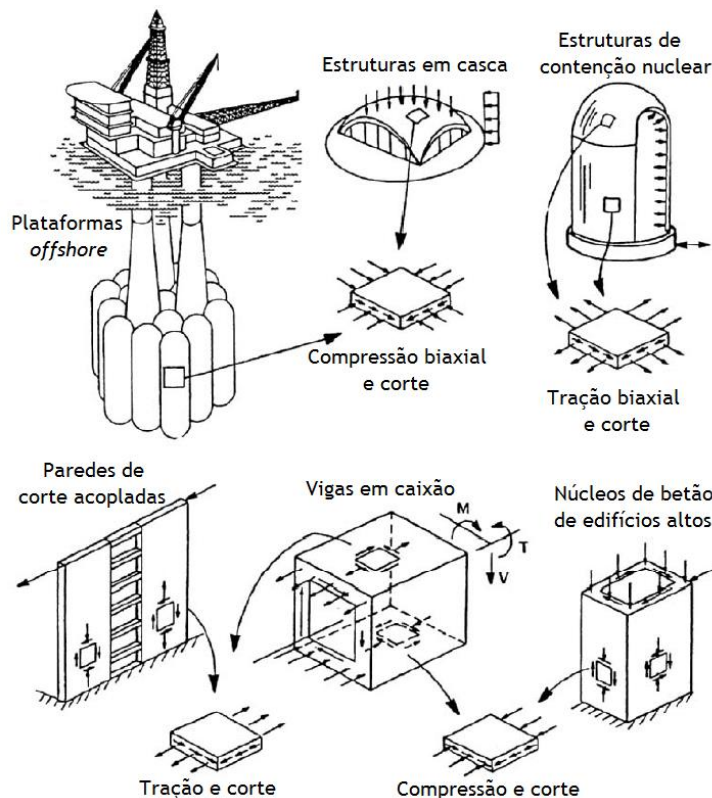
Simplificação de estruturas de betão armado em elementos de placa [26].
